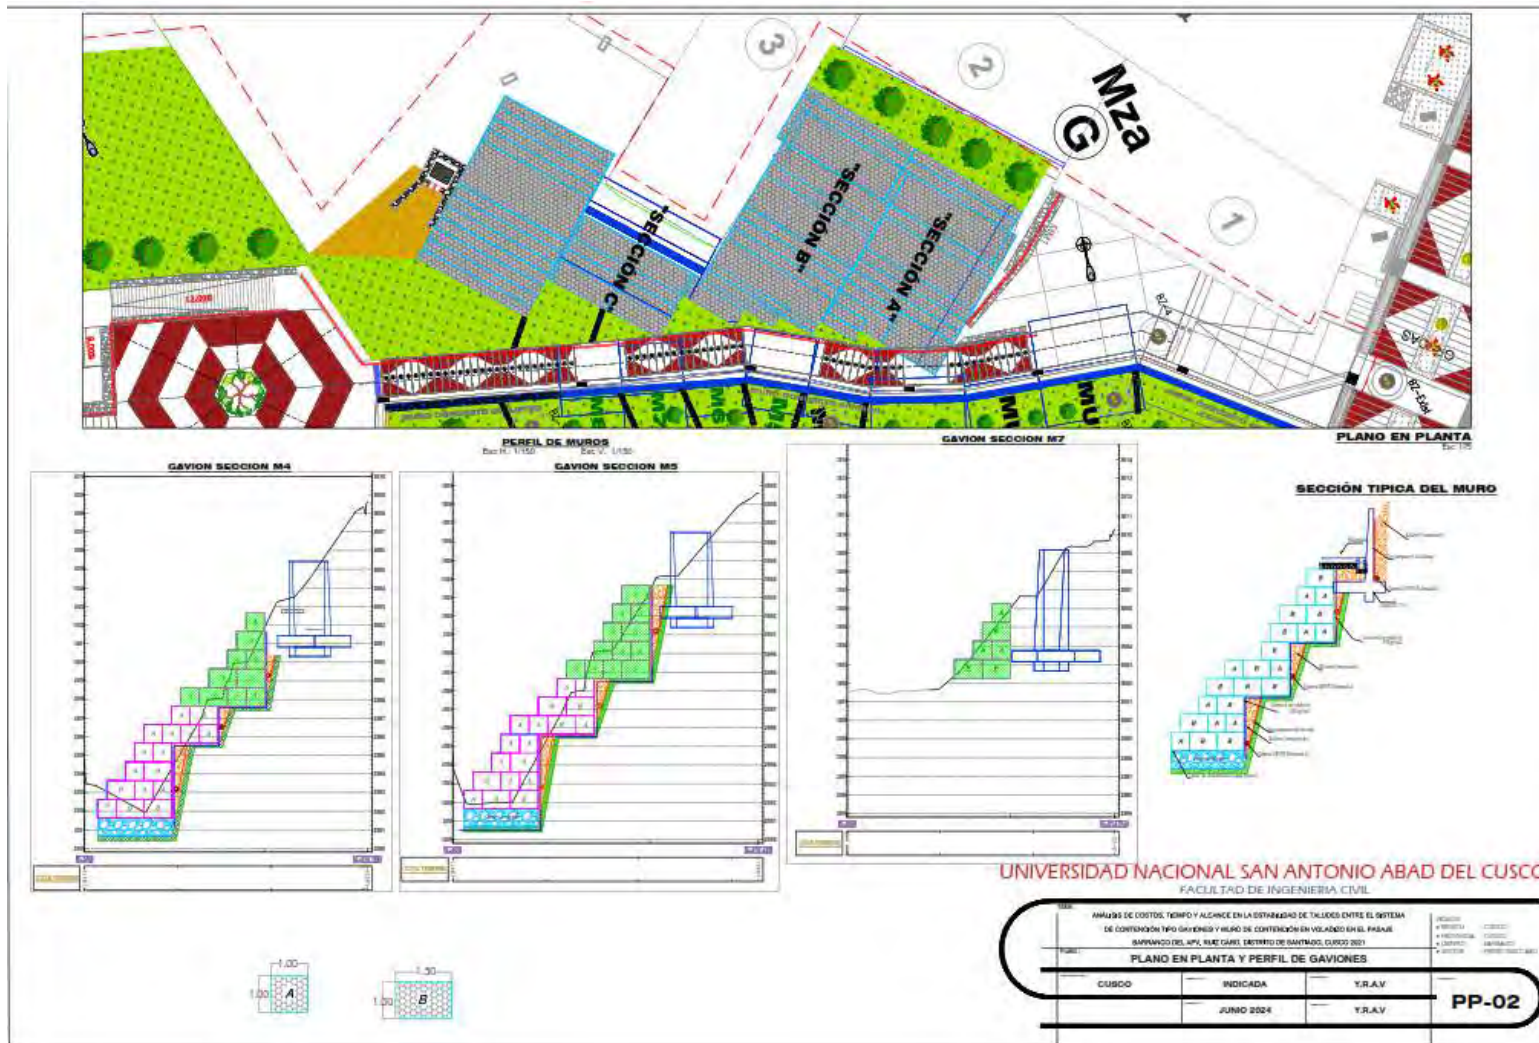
Plano de Planta y Perfil de Gaviones y Muros de Contención
